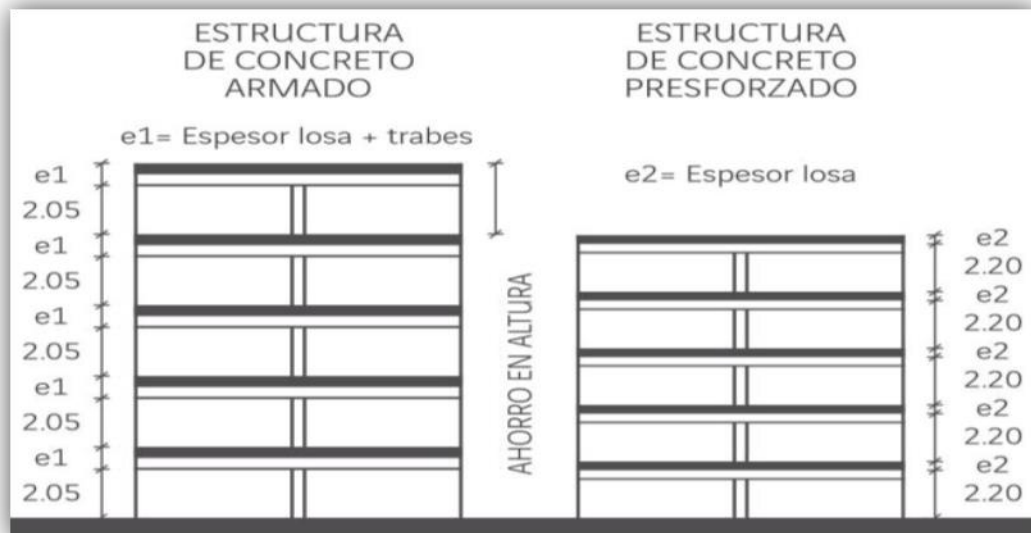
Comparación entre los edificios de hormigón armado y de hormigón presforzado.
